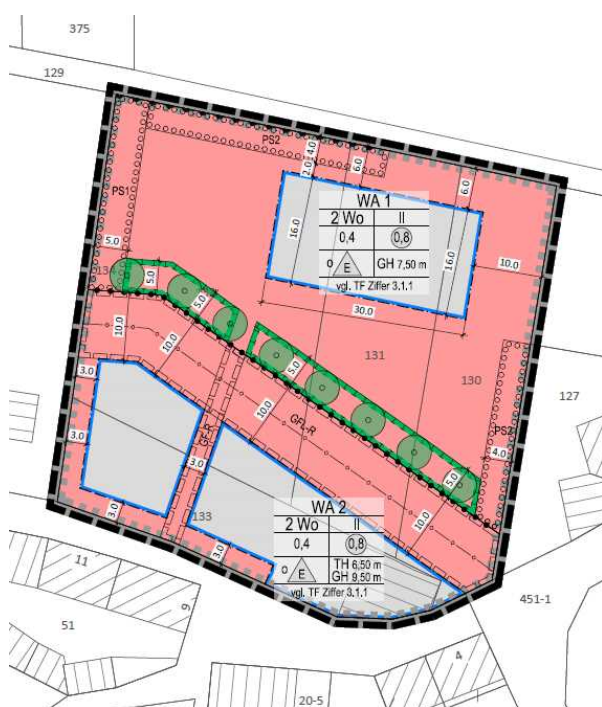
Entwurf des Bebauungsplans „Osterberg, 1. Teiländerung“ (Stand: April 2023)
